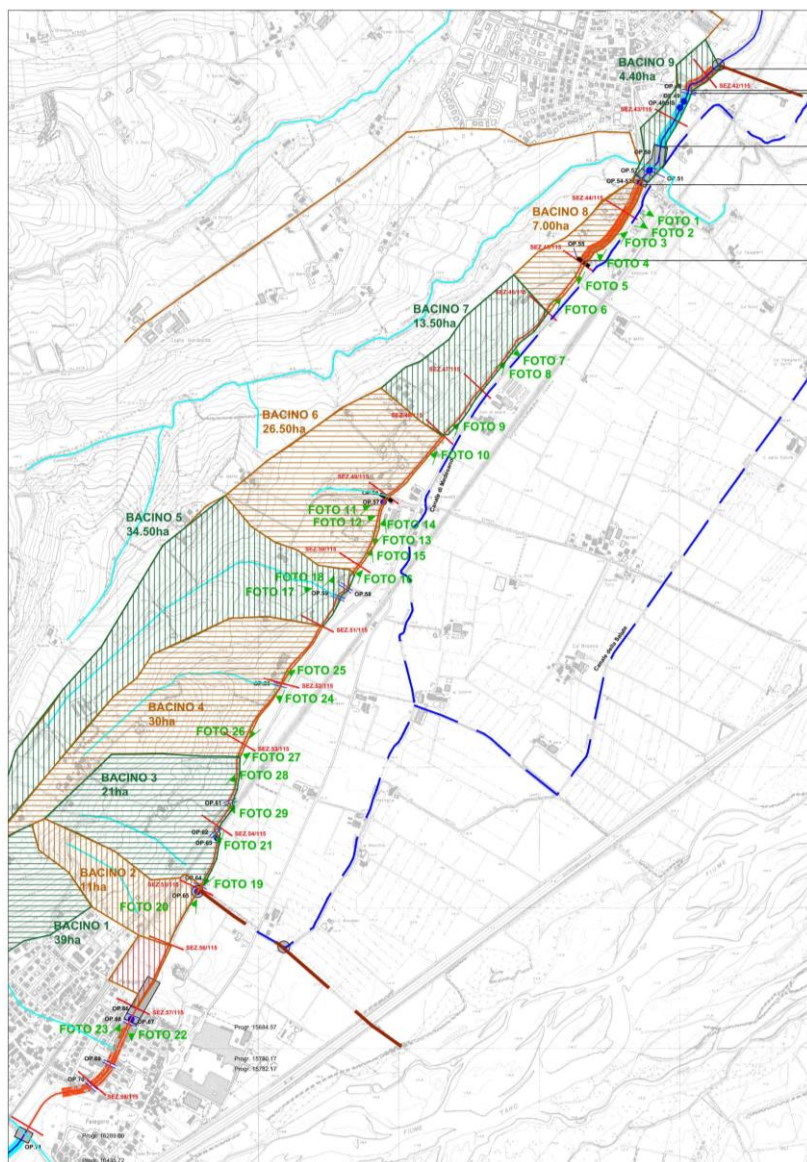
PLANIMETRIA DEL CANALE DEL DUCA, SU BASE CTR, CON INDICAZIONE DELLE SEZIONI TRASVERSALI E DEI BACINI COLLINARI Afferenti
